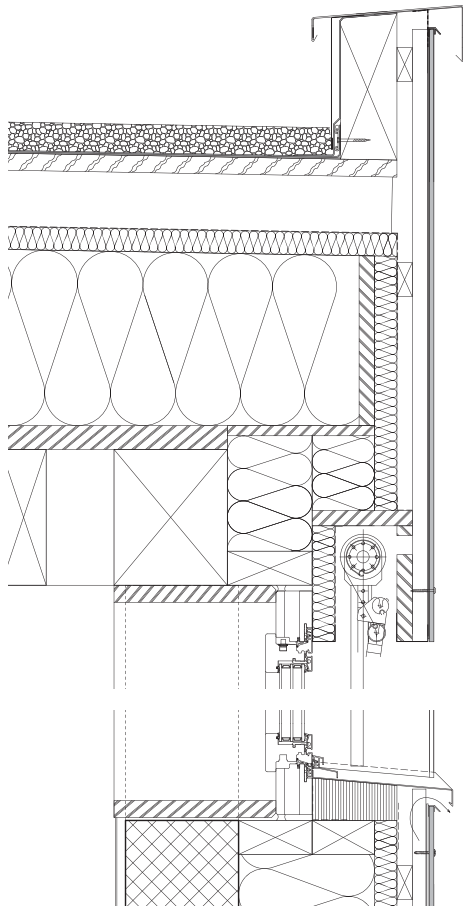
Unterlüftung des Daches, Dachanschluss, Sturz und Fensterbank (Schnitt) des Einfamilienhauses Beer in Paspels.
